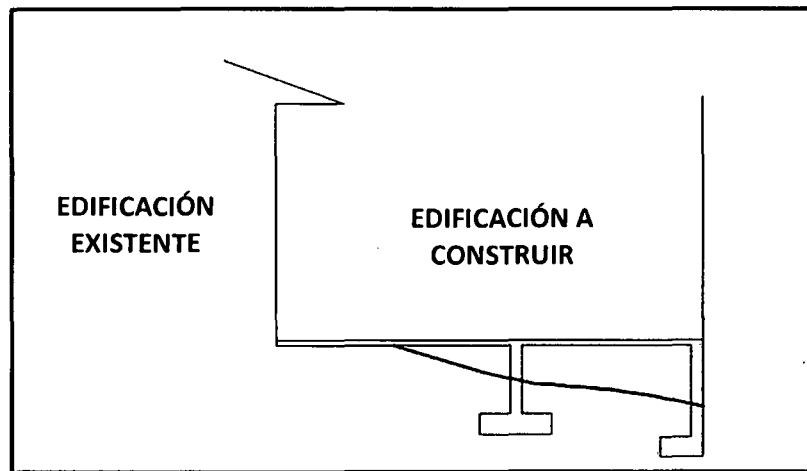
Vista en elevación de una construcción a ampliar con una existente.
